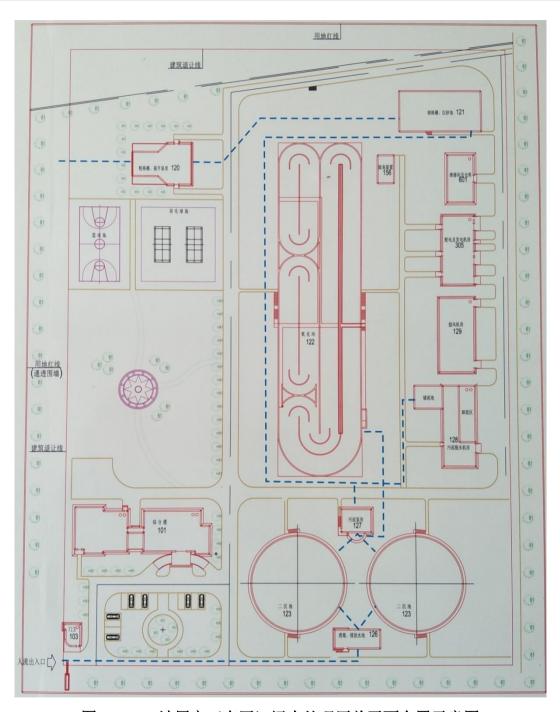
汕尾市(东区)污水处理厂总平面布置示意图
